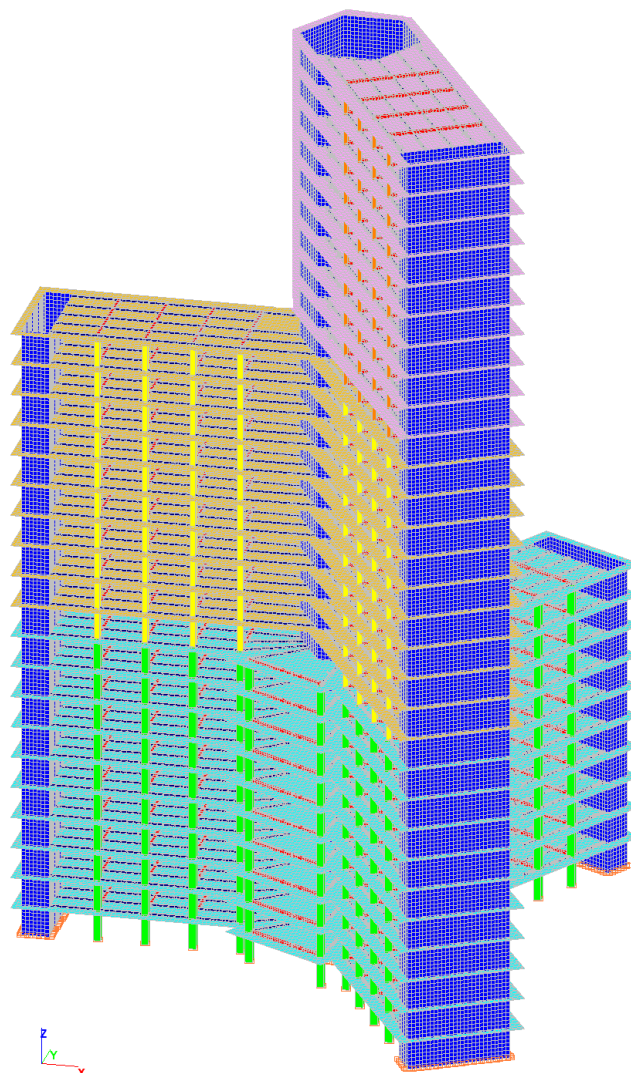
Расчетная схема здания в ПК SCAD
